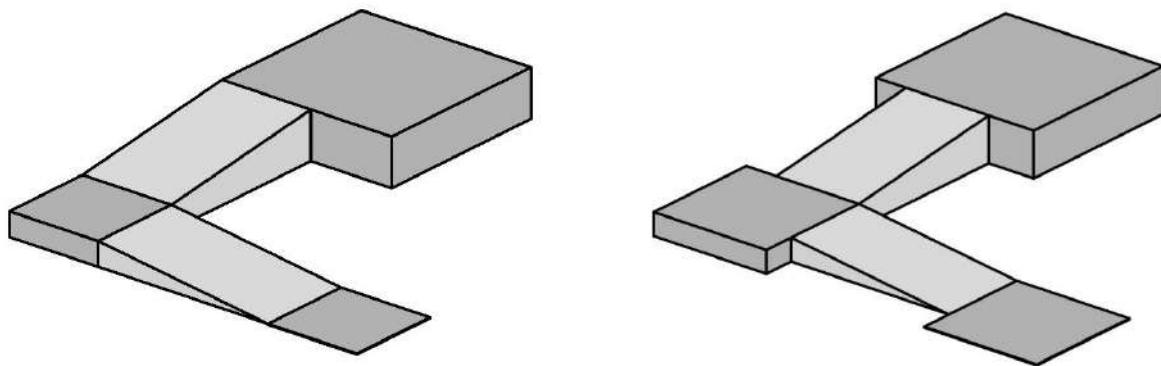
, б – Пандус выполнен с нарушением требований к габаритам и расположению промежуточной горизонтальной площадки
